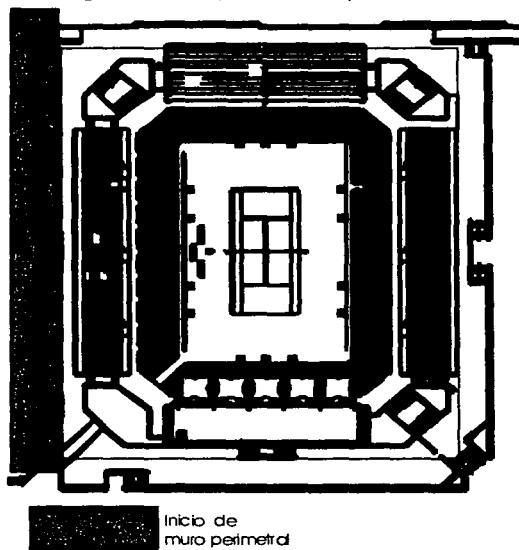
Inicio de muro perimetral en su zona poniente.
